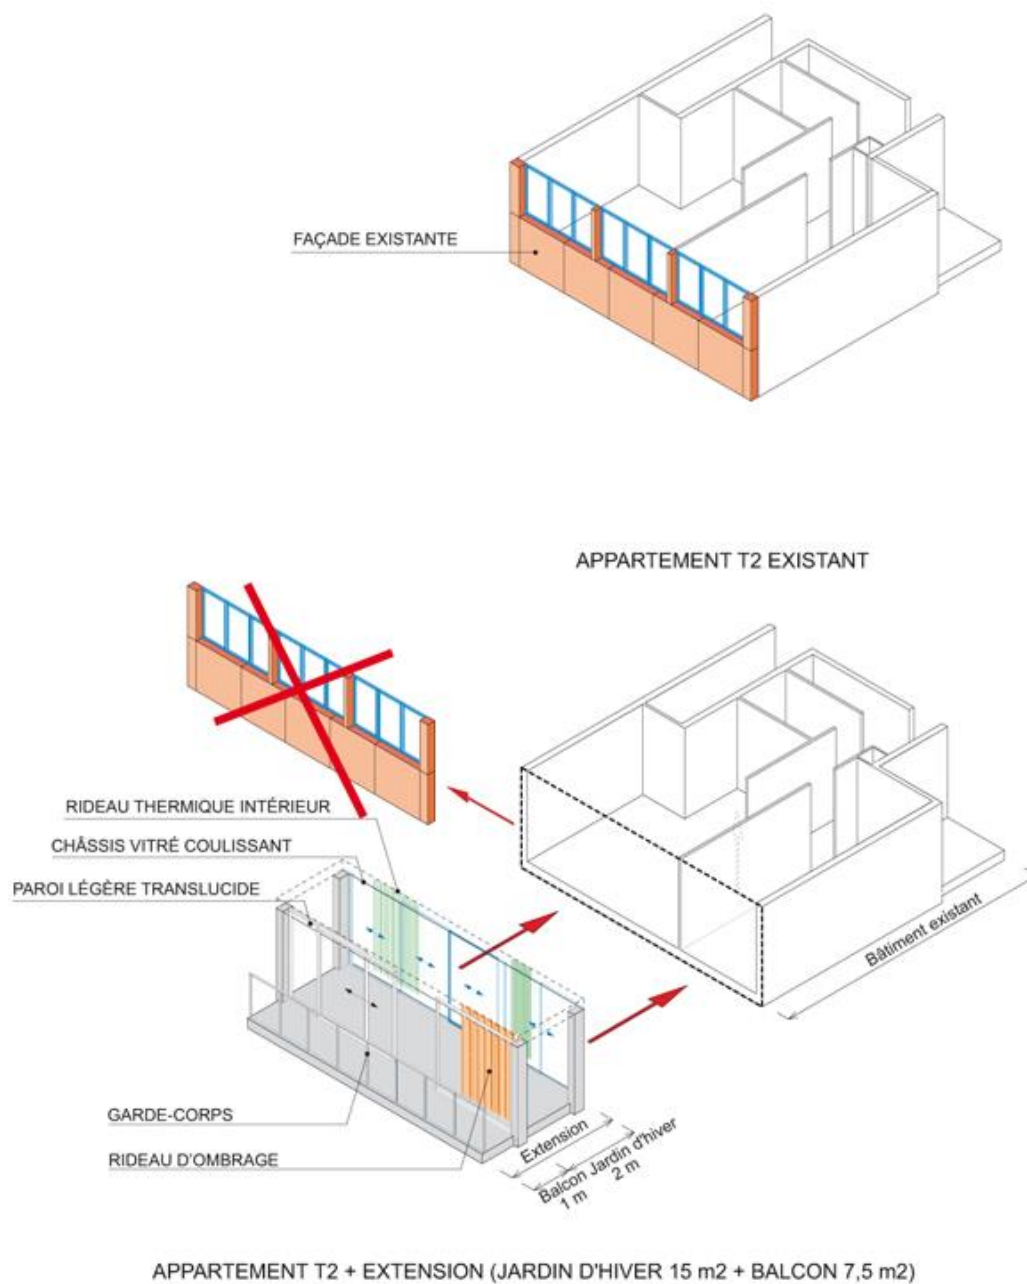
Diagrama explicativo do sistema construtivo da proposta. Imagem: Lacaton&Vassal
